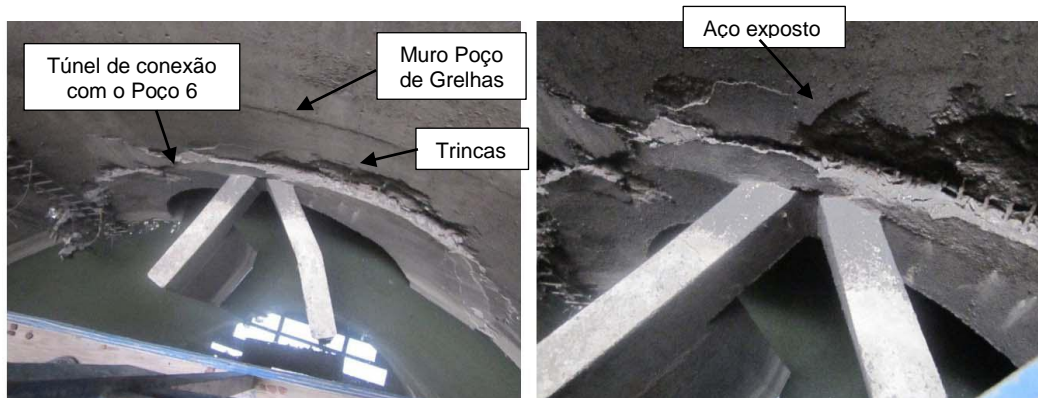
Zona de ruptura estrutural da conexão do muro interno do Poço de Grelhas com o túnel (Adaptado de CONAGUA, 2013)
